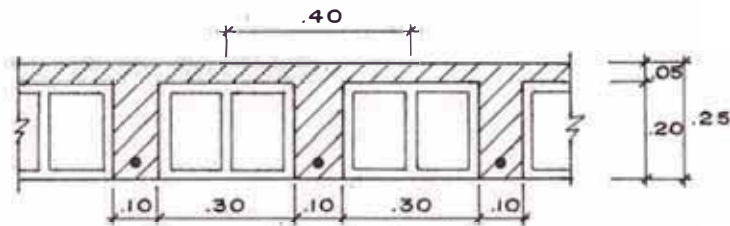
Sección transversal típica de losas aligeradas H = 0.25 m
